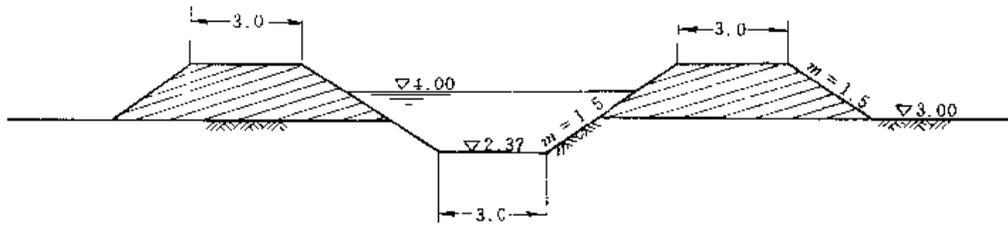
输水渠横断面尺寸示意图 (单位: m)
